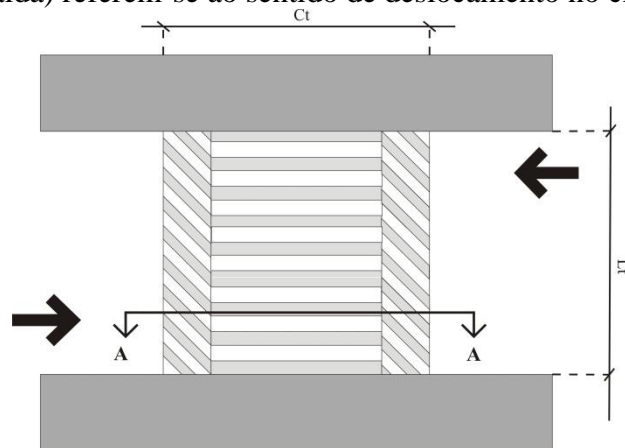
Vista superior de uma plataforma – travessia elevada com perfil trapezoidal
